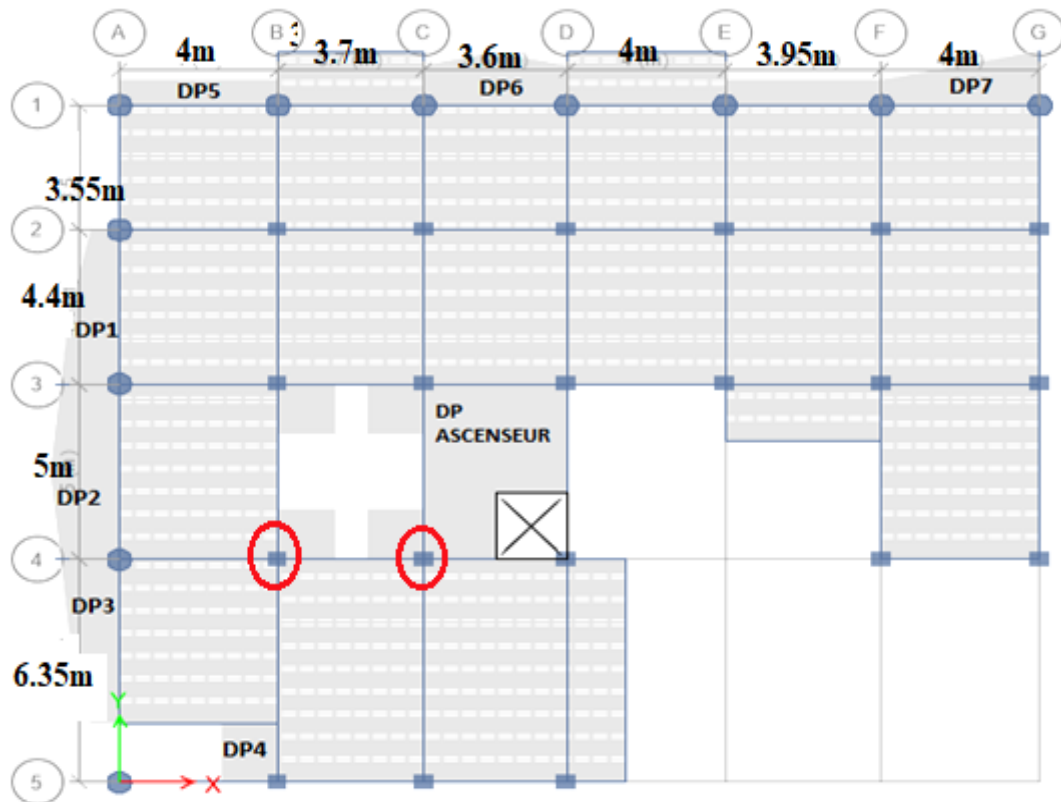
Vue en plan d'identification des poteaux de la descente de charges
